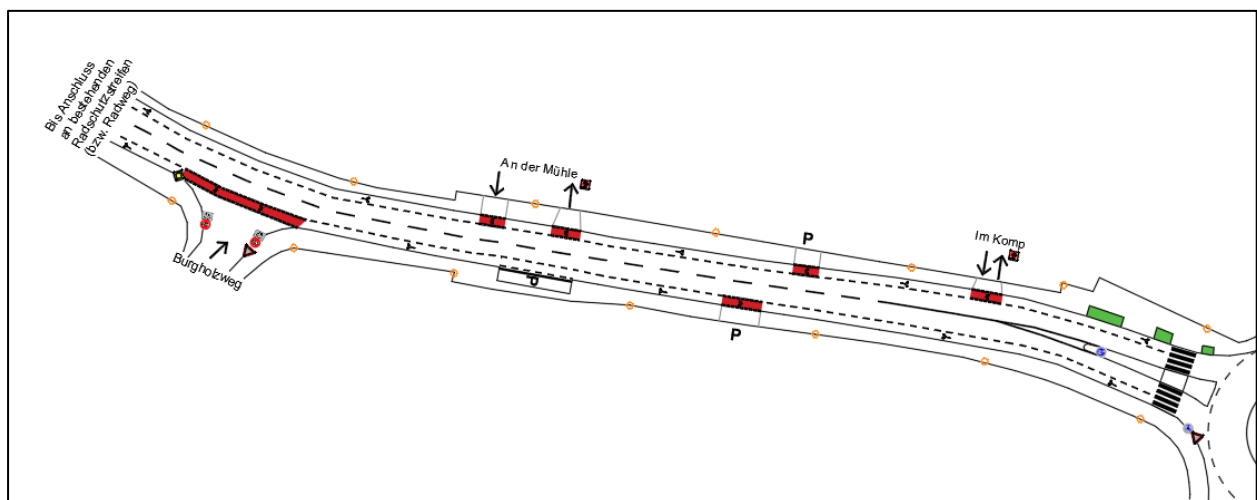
Hauptstraße, Planausschnitt P13 (eigene Darstellung)
